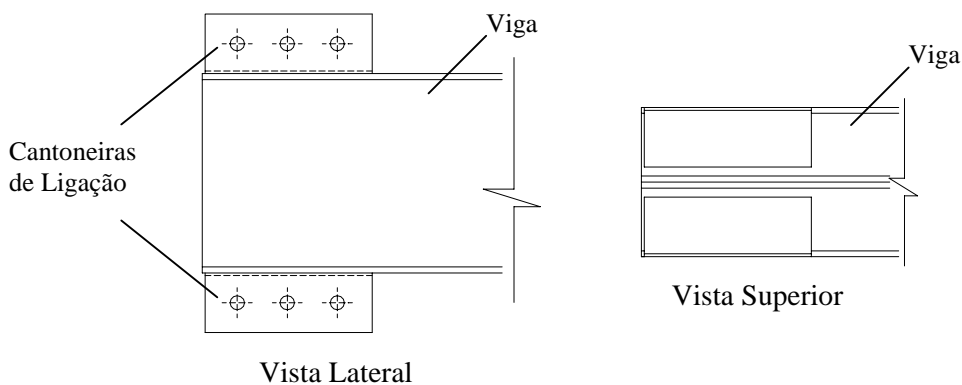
Detalhe da viga do protótipo com as Cantoneiras de Ligação.
